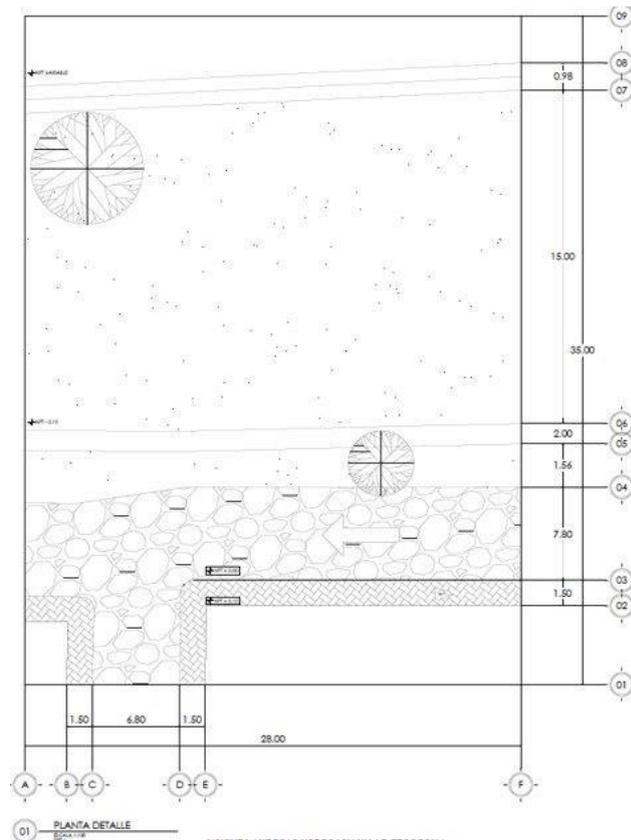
Propuesta planta 1 - Tramo 1
